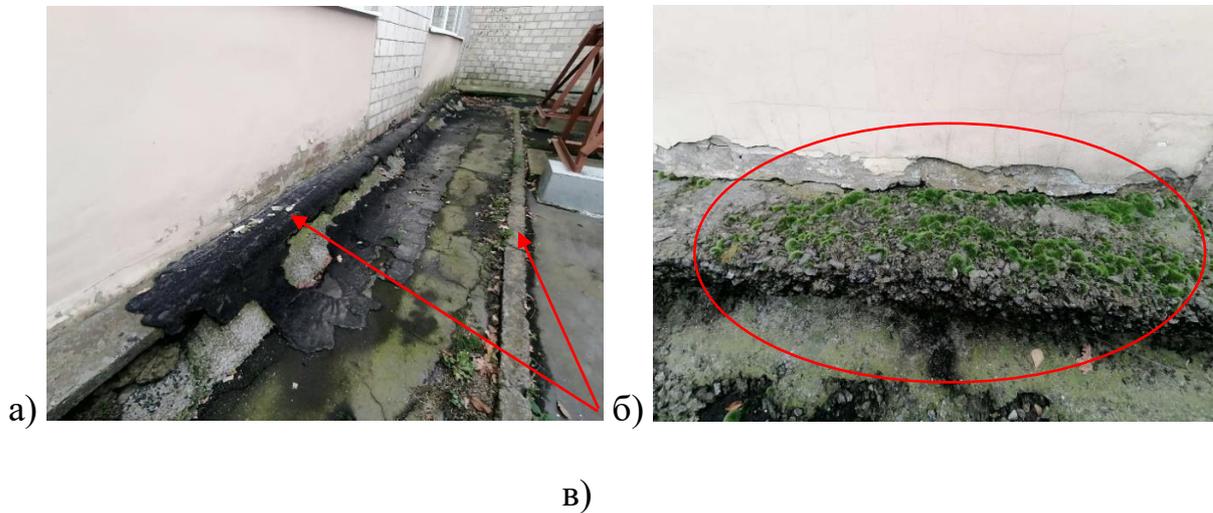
Недостатня ширина (900 мм) бетонного вимощення вздовж фасаду в осях 3-12/Д (а) ;
